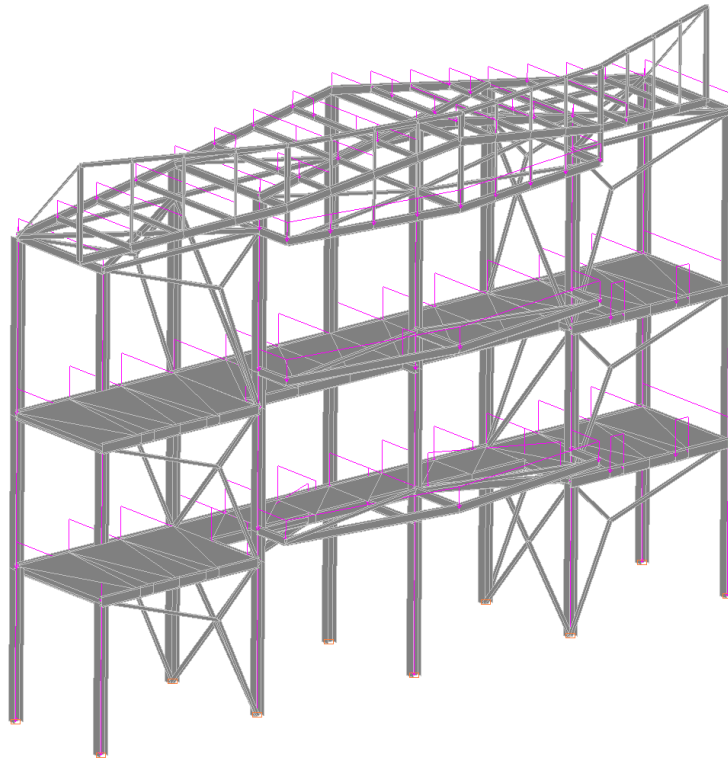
Нагрузка на каркас от постоянной нагрузки
